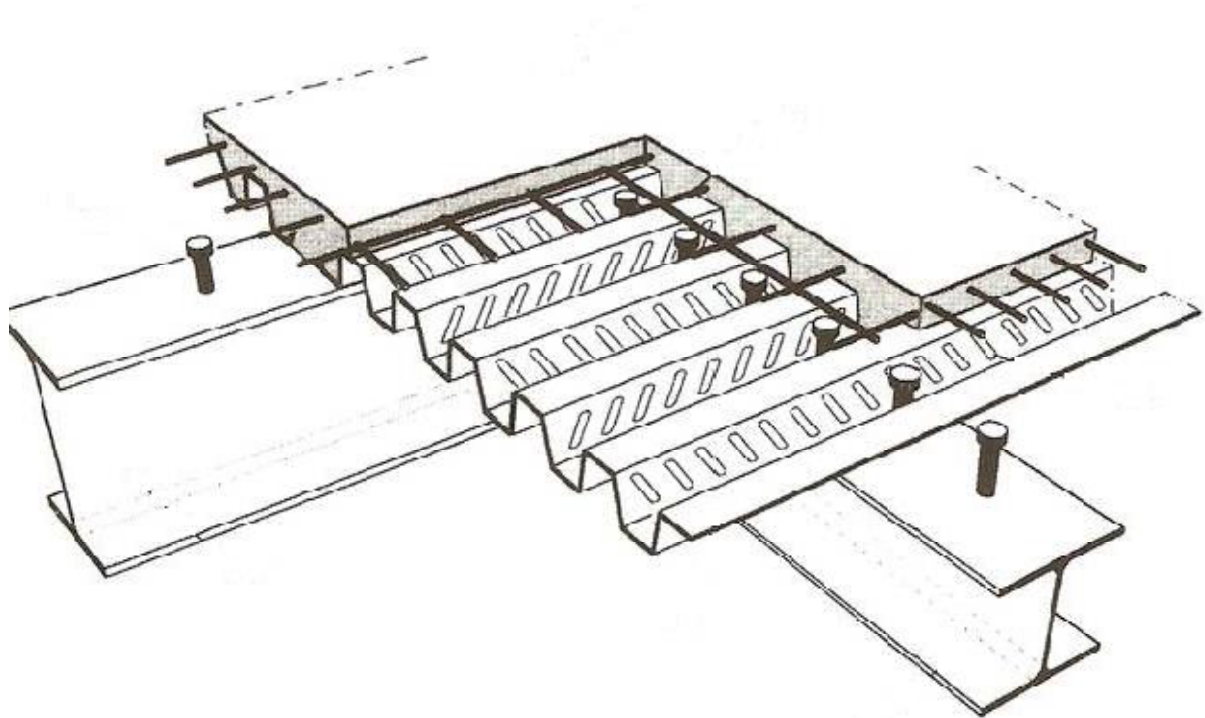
Représentation de la liaison entre une dalle mixte et les poutres porteuses par goujons connecteurs.
